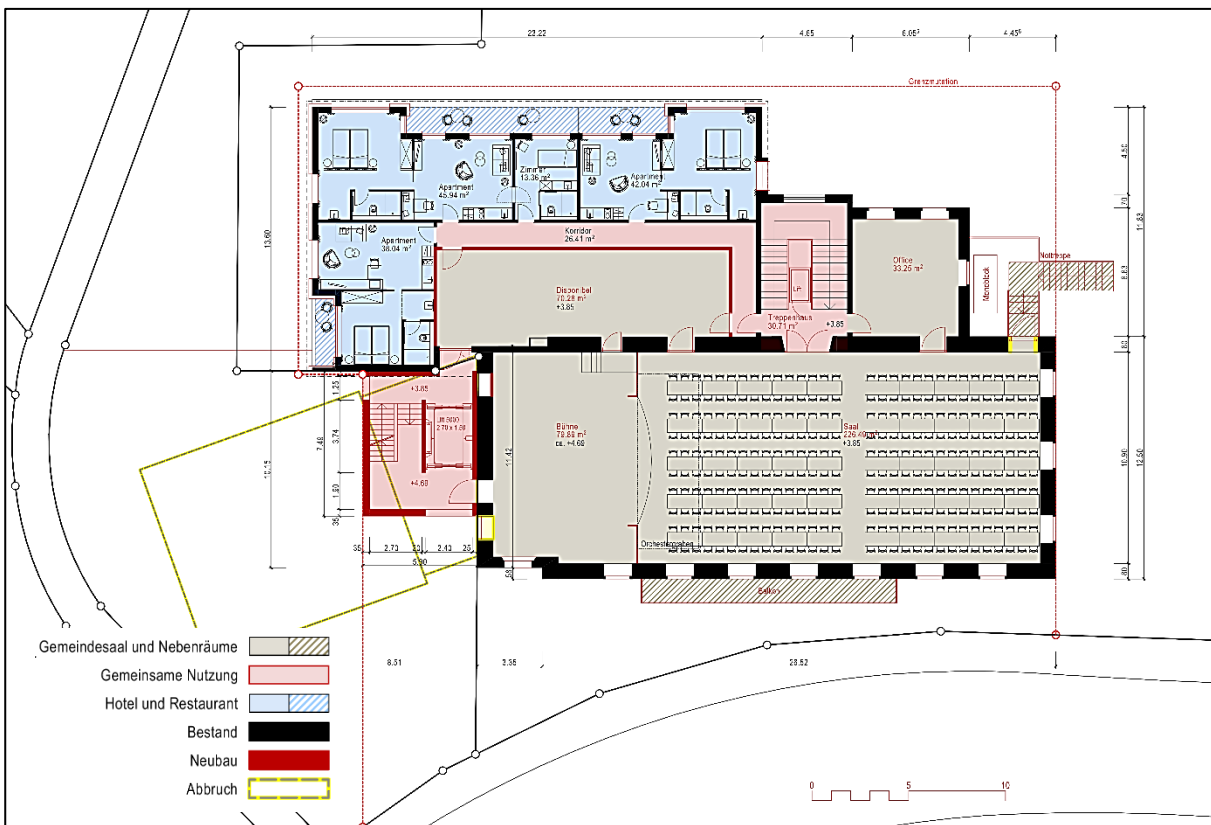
Grundriss 1. Obergeschoss, Stand 18.10.2022
